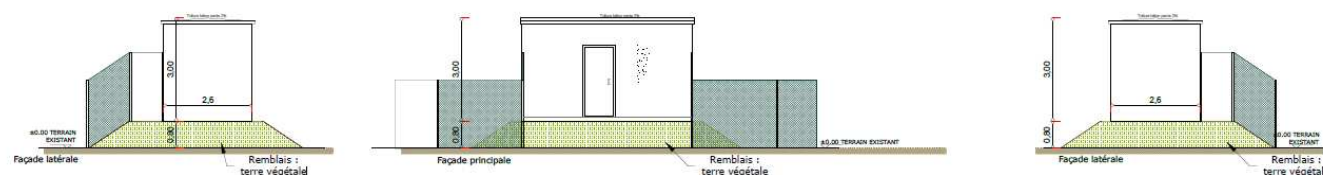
Vues des façades du poste de livraison prévu sur site
